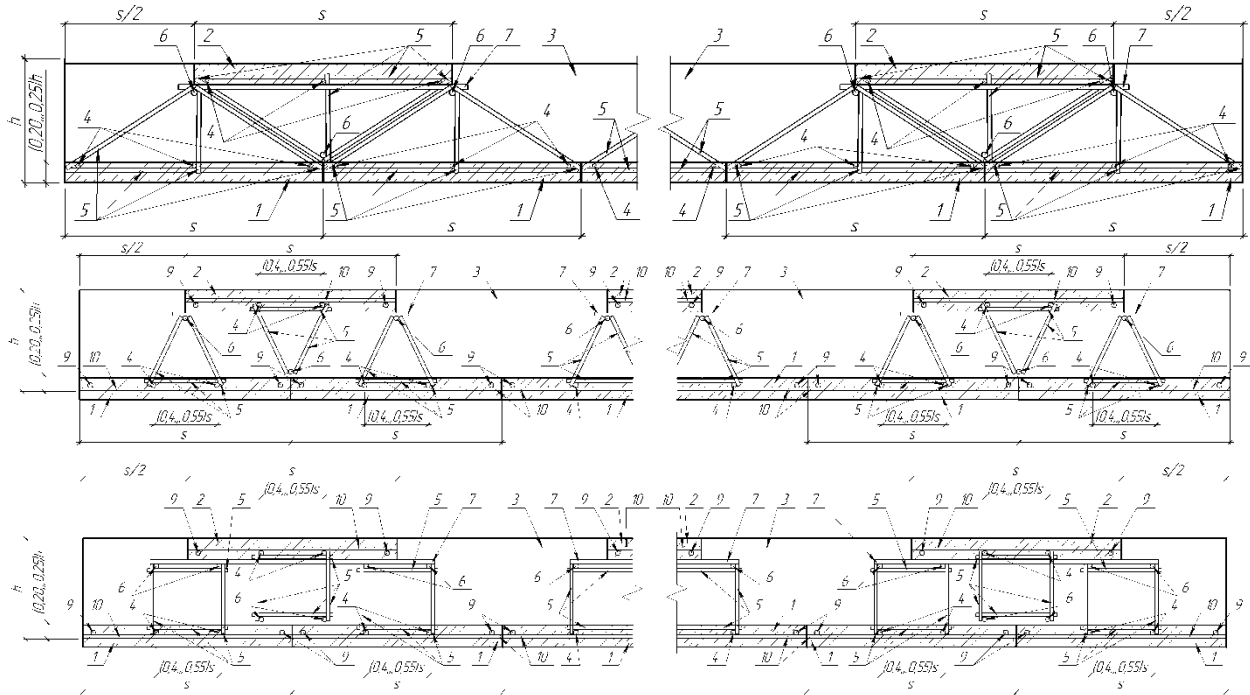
Поперечні перерізи шаруватої залізобетонно-пінобетонної плити
